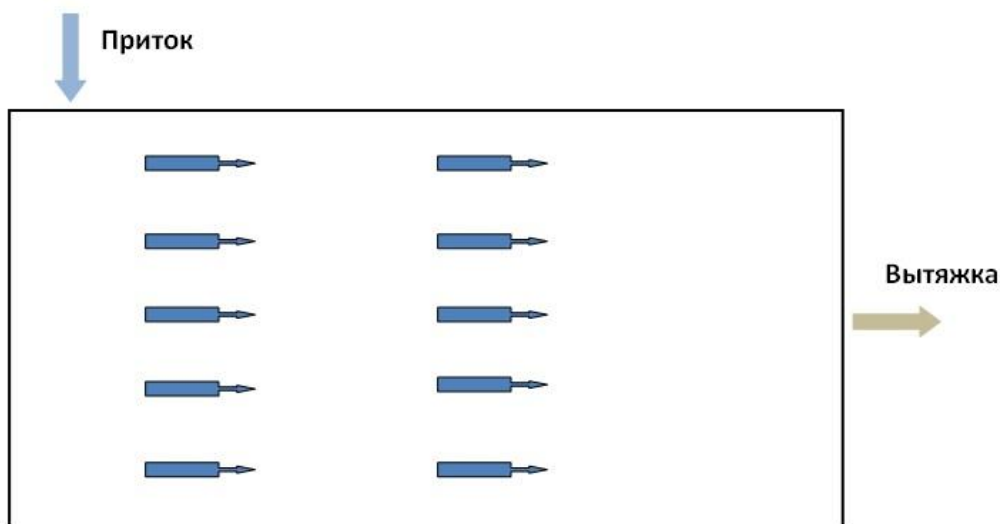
Схема струйной вентиляции (с использованием струйных вентиляторов)
